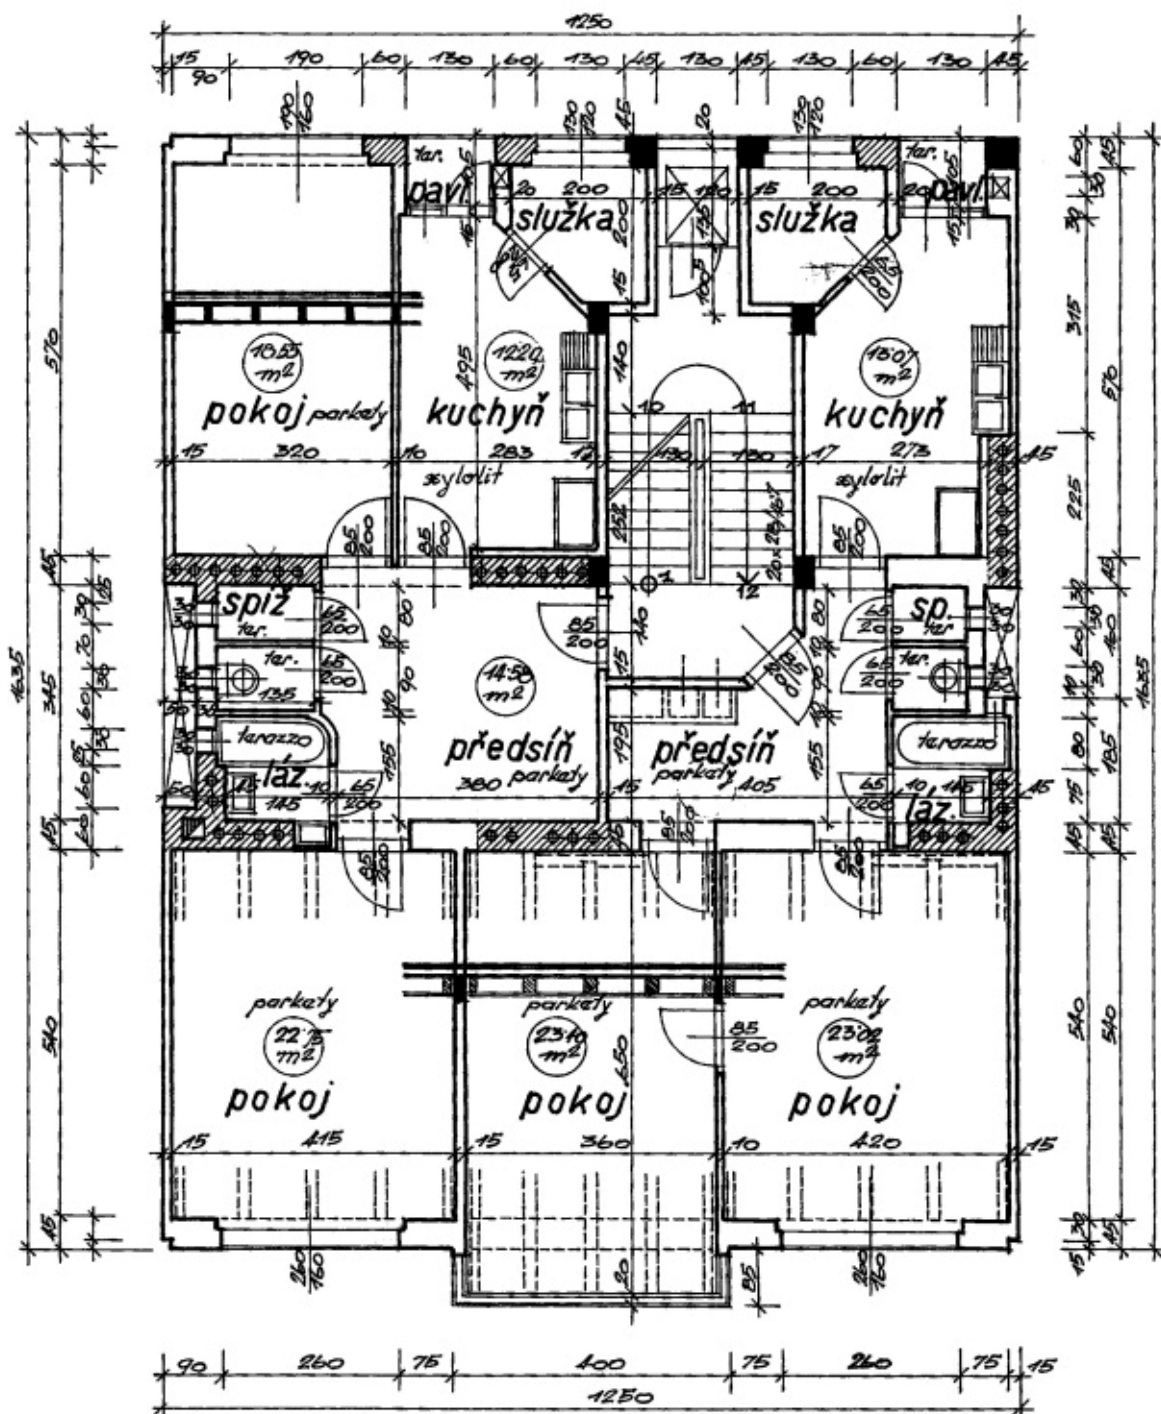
Půdorys 2.NP obytného nájemního domu s ordinací ⁷²
